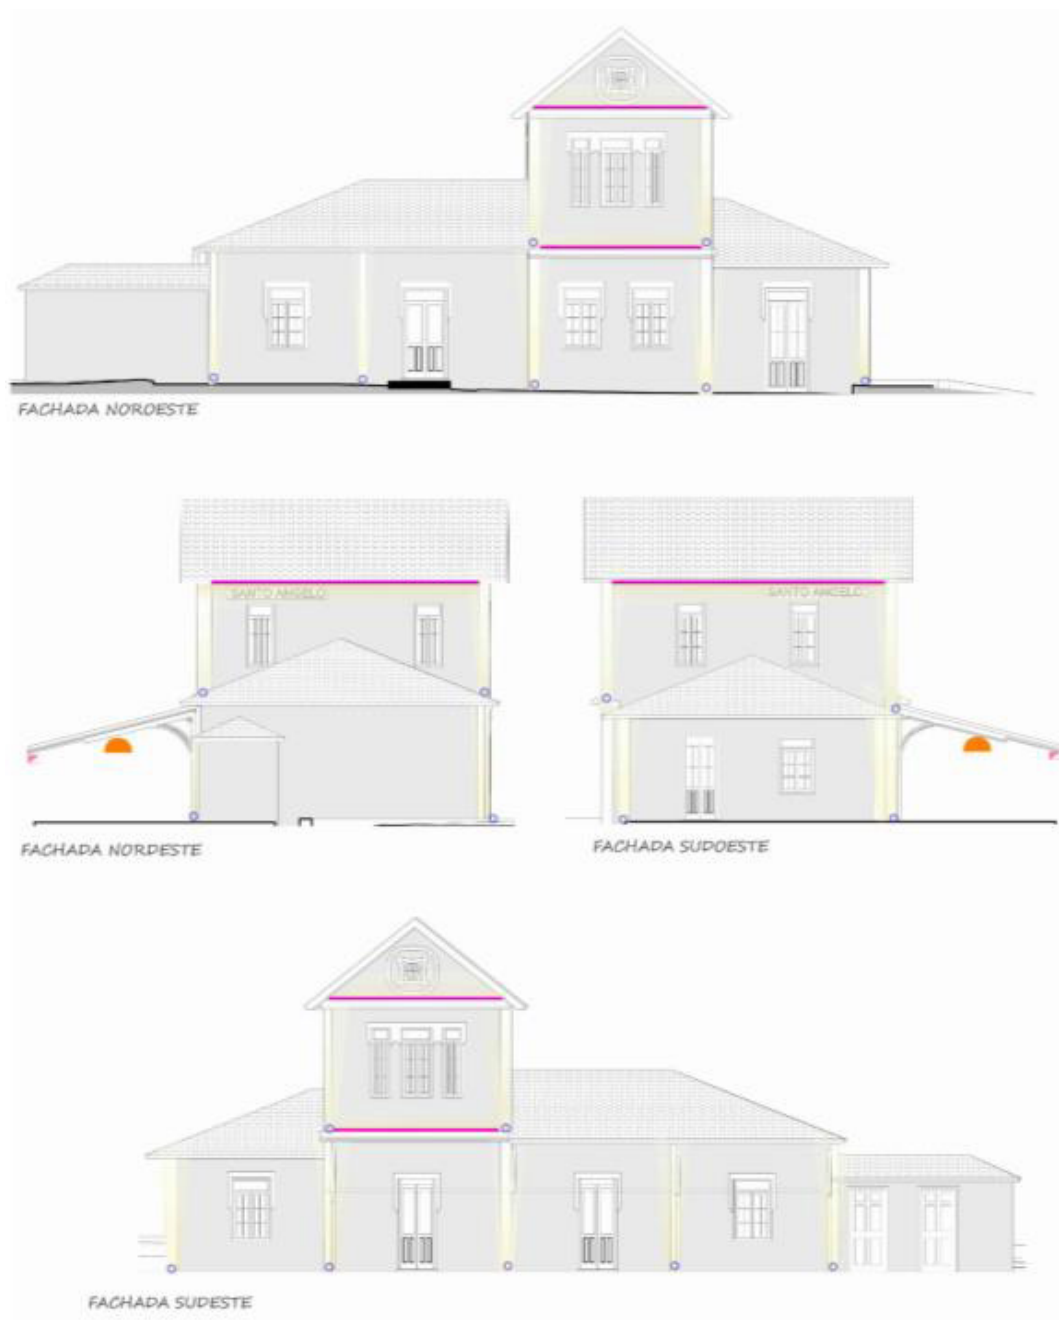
Locação dos pontos de iluminação nas fachadas.
